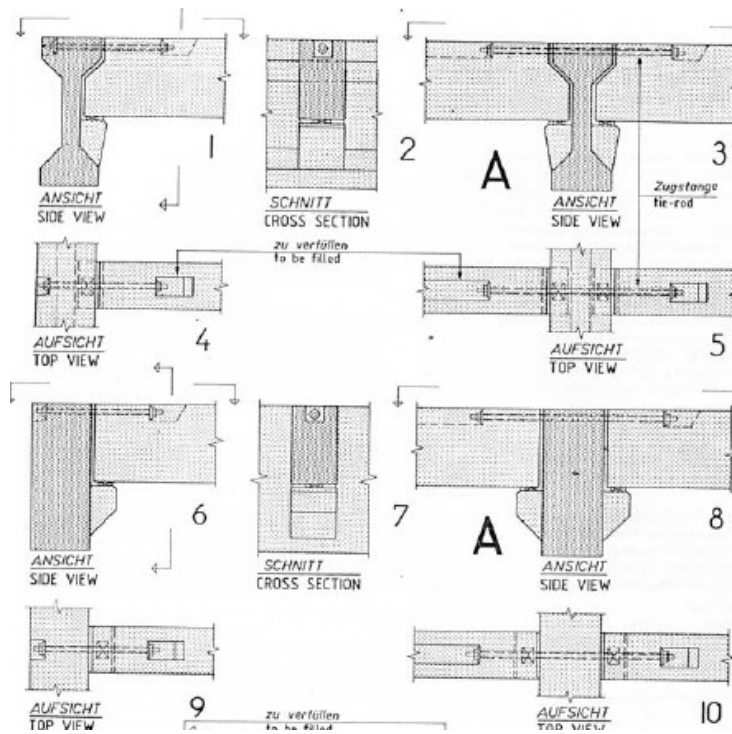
Ligação por consolo de betão e barras de pré-esforço (Stupré, 1981)
